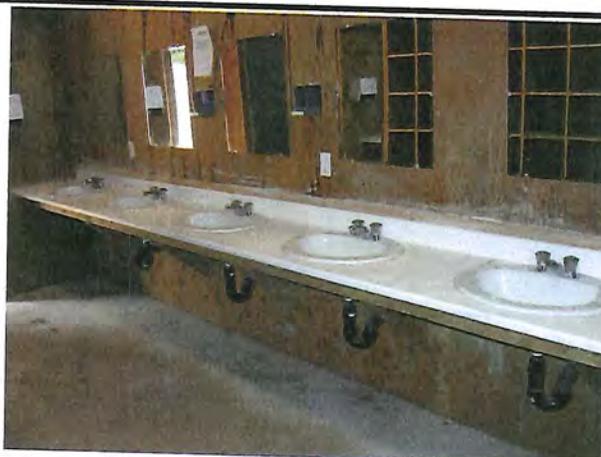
Toilettes du bloc sanitaire des jeunes de la section Biluim
